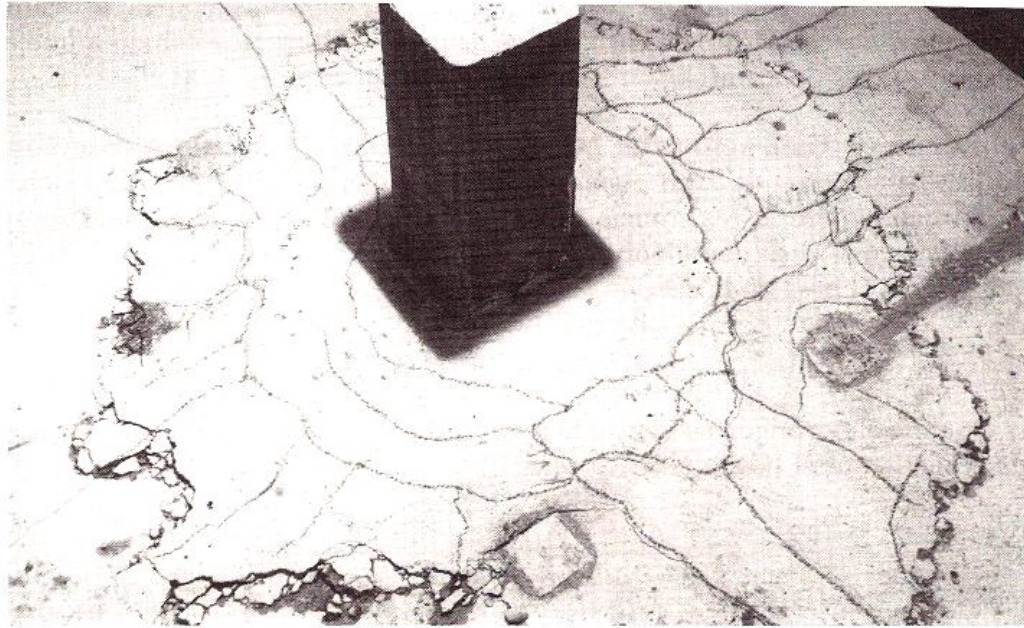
Fisuras de funcionamiento de una loza armada
